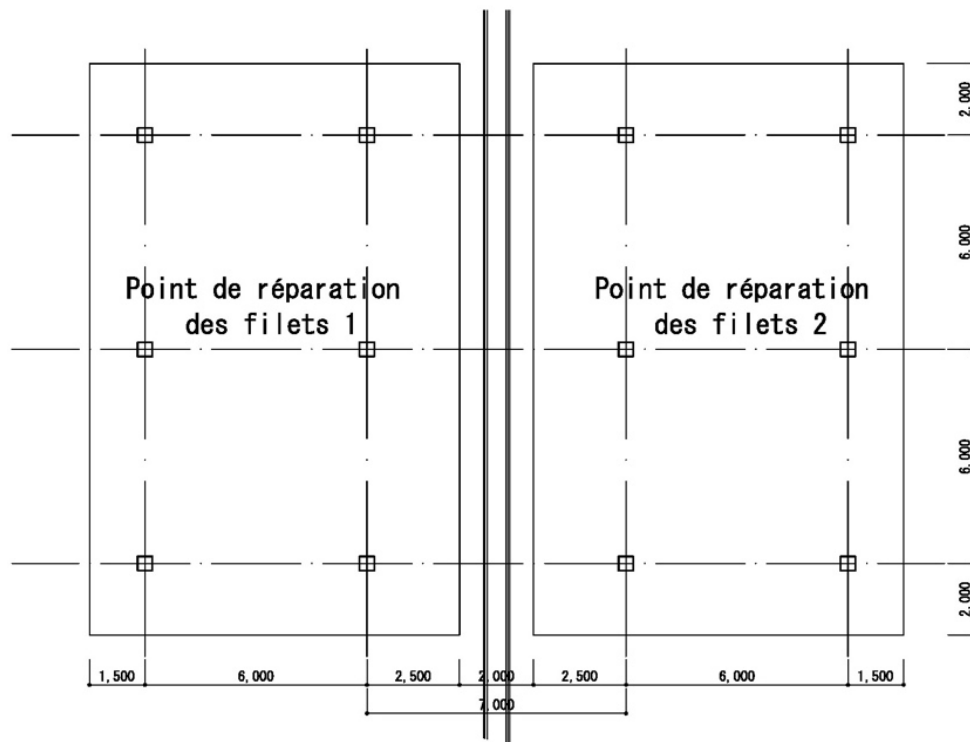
Débarcadère de Kaporo Plan de masse S : 1/500
